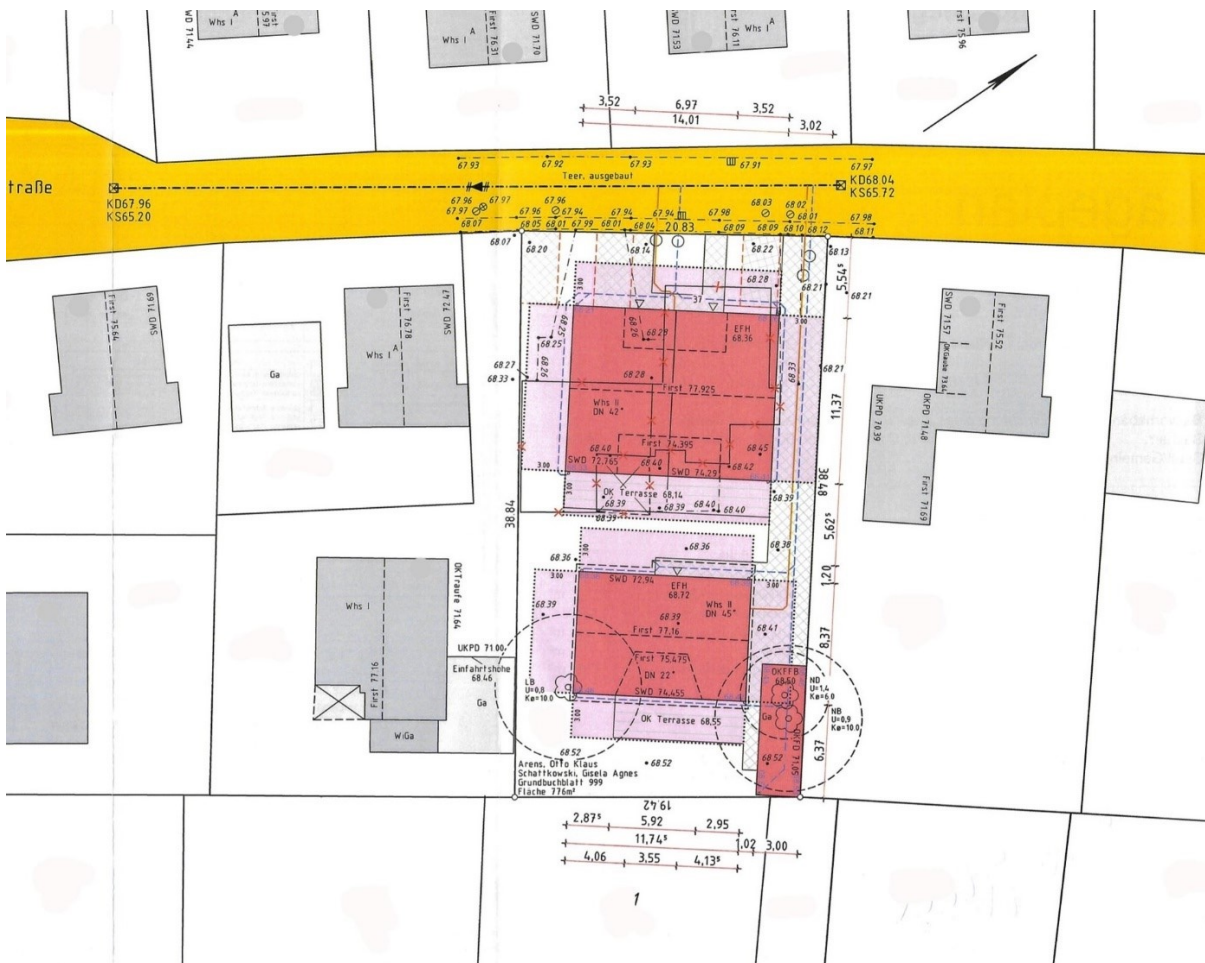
Lageplan Bauantrag Gneisenaustraße
